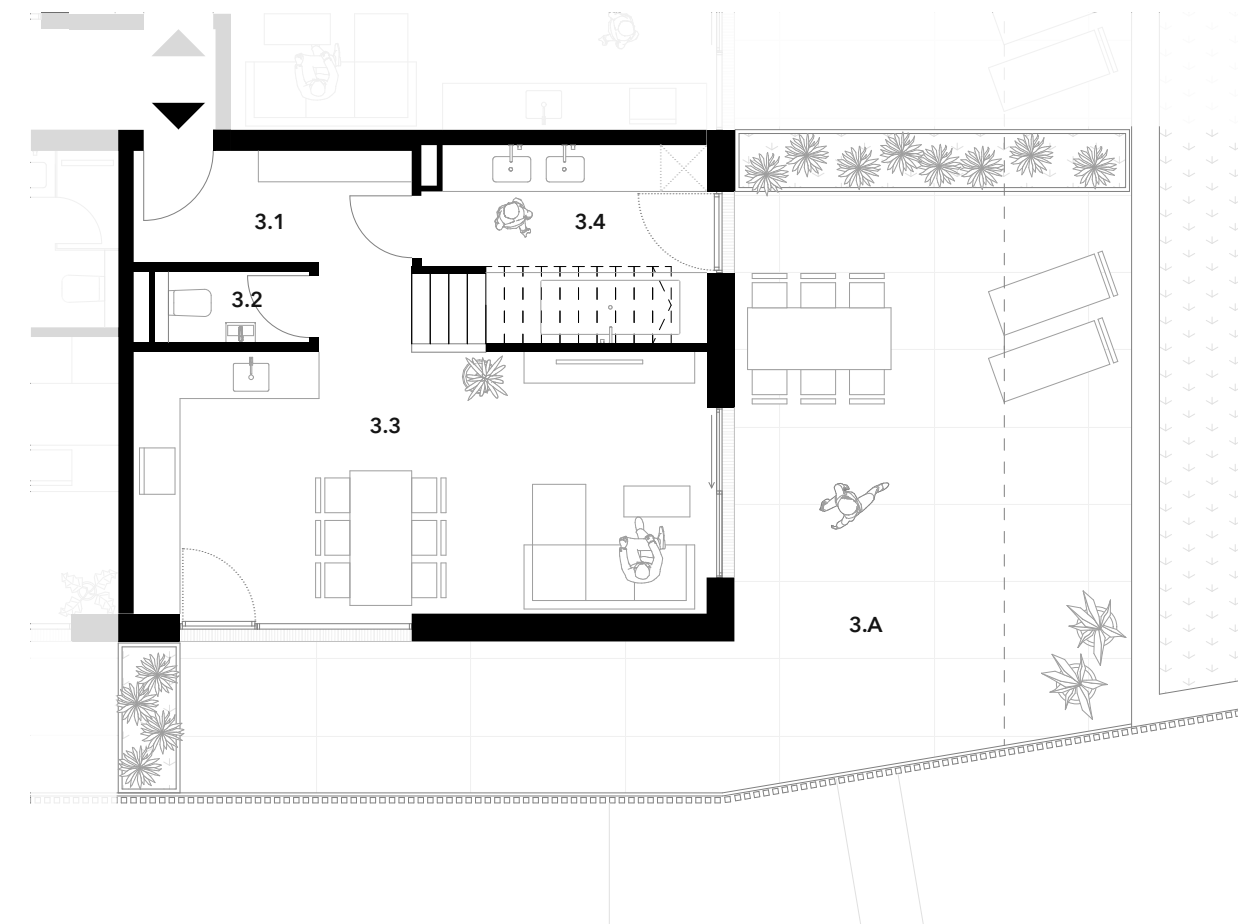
Grundriss Untergeschoß TOP 3
